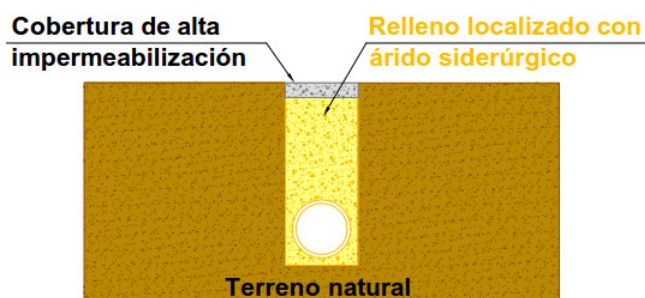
RELLENO DE ZANJAS / CUBRICIÓN DE TUBERÍAS BAJO COBERTURA DE ALTA IMPERMEABILIZACIÓN.
